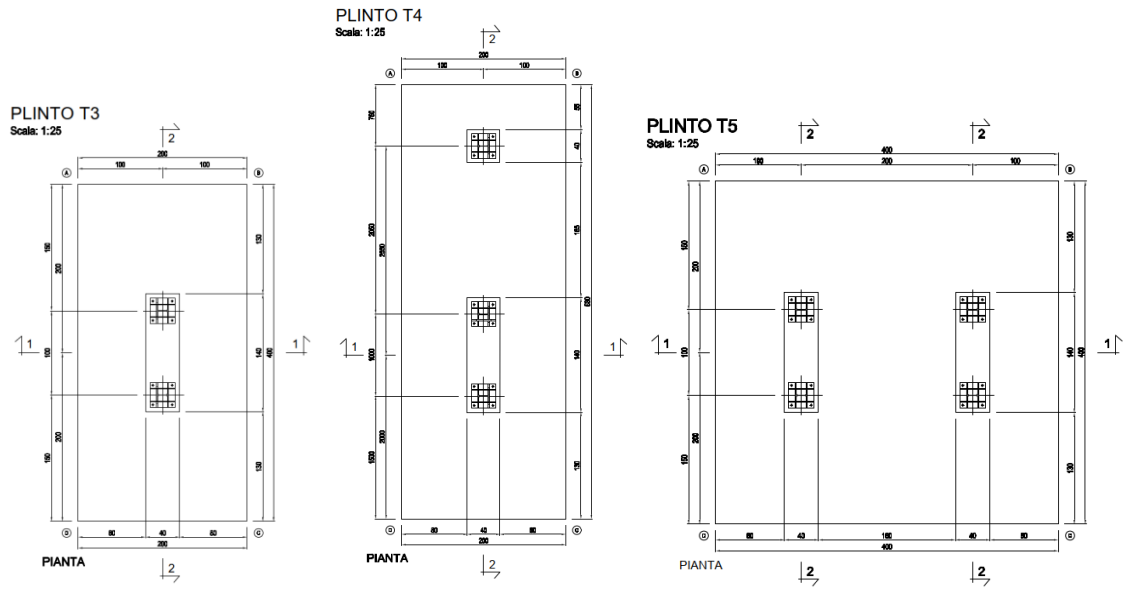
Geometria della fondazione - PLINTI T3, T4 e T5
